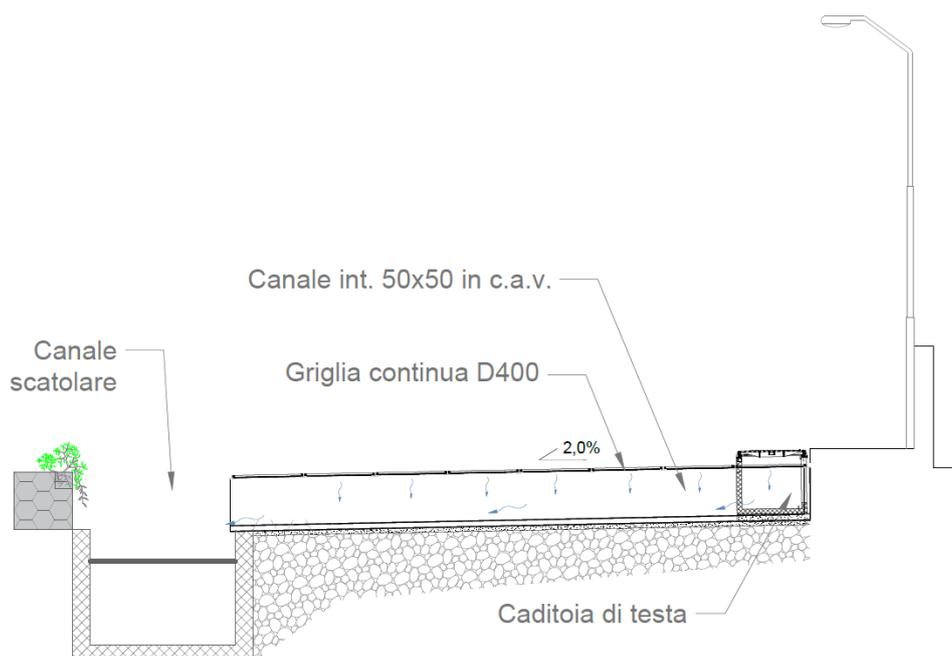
Schema delle opere del progetto definitivo (Stralcio 1)
